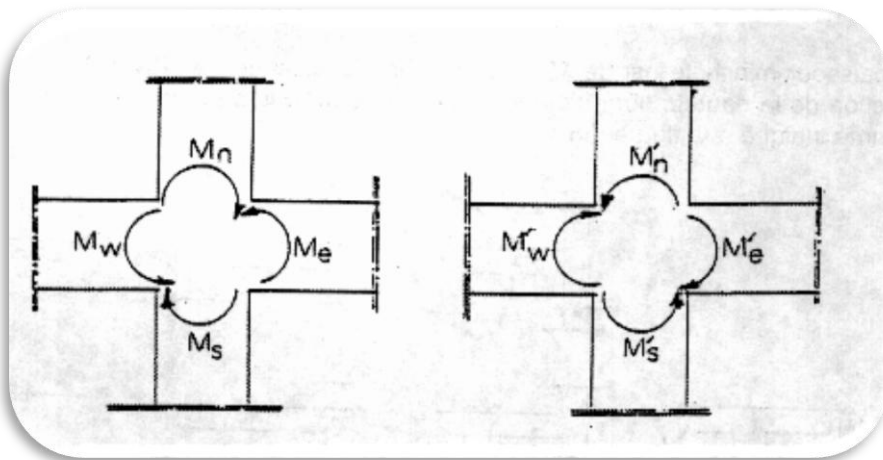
Dimensionnement d'un nœud poutre-poteau
